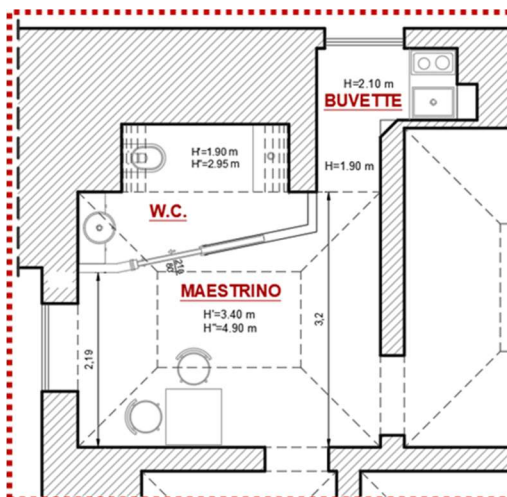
Stralcio planimetrico con soluzione progettuale n. 2
